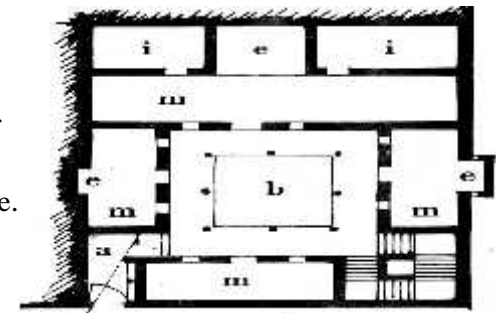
plan et coupe de La maison traditionnelle de la casbah d'Alger
